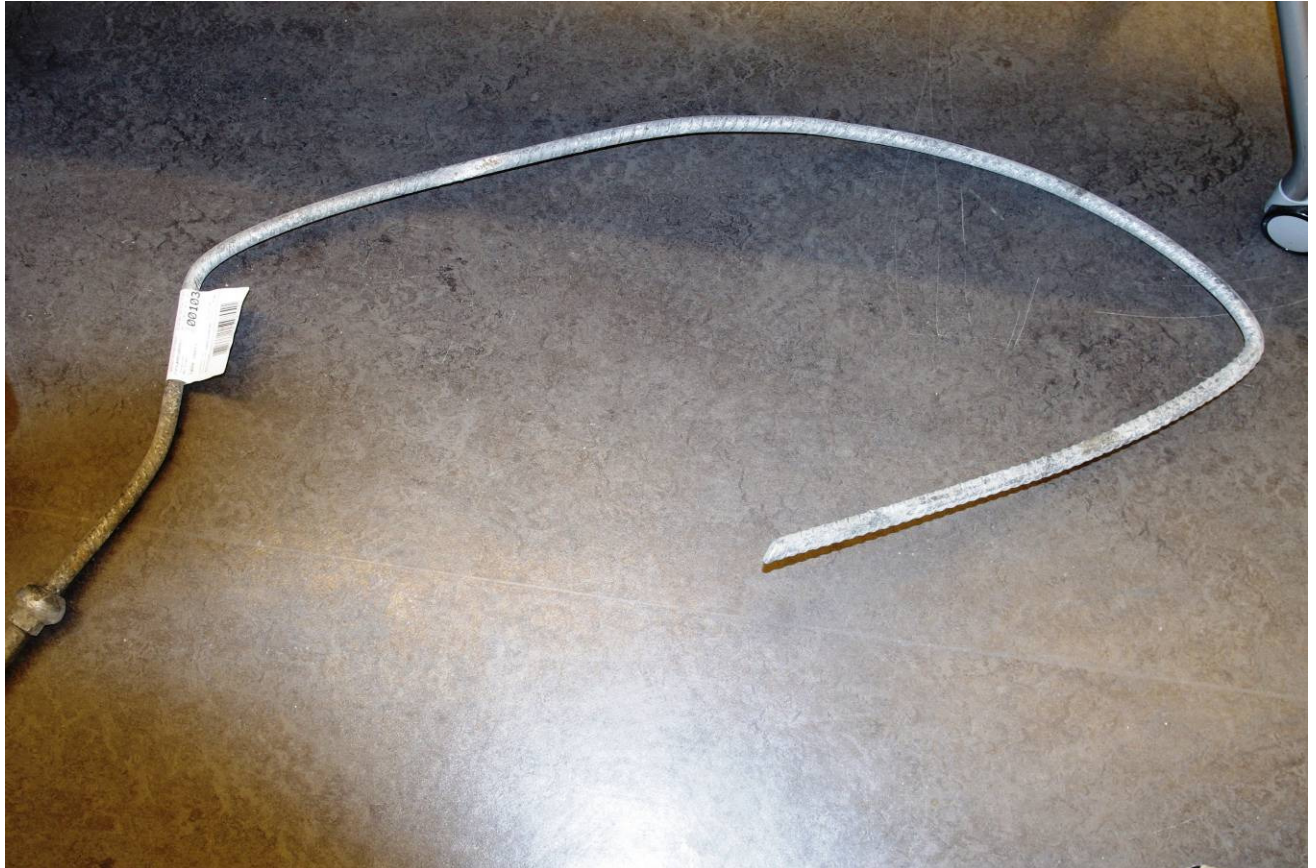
Rørbolter fra Kvalsundtunnelen tildekket med sprøytebetong
